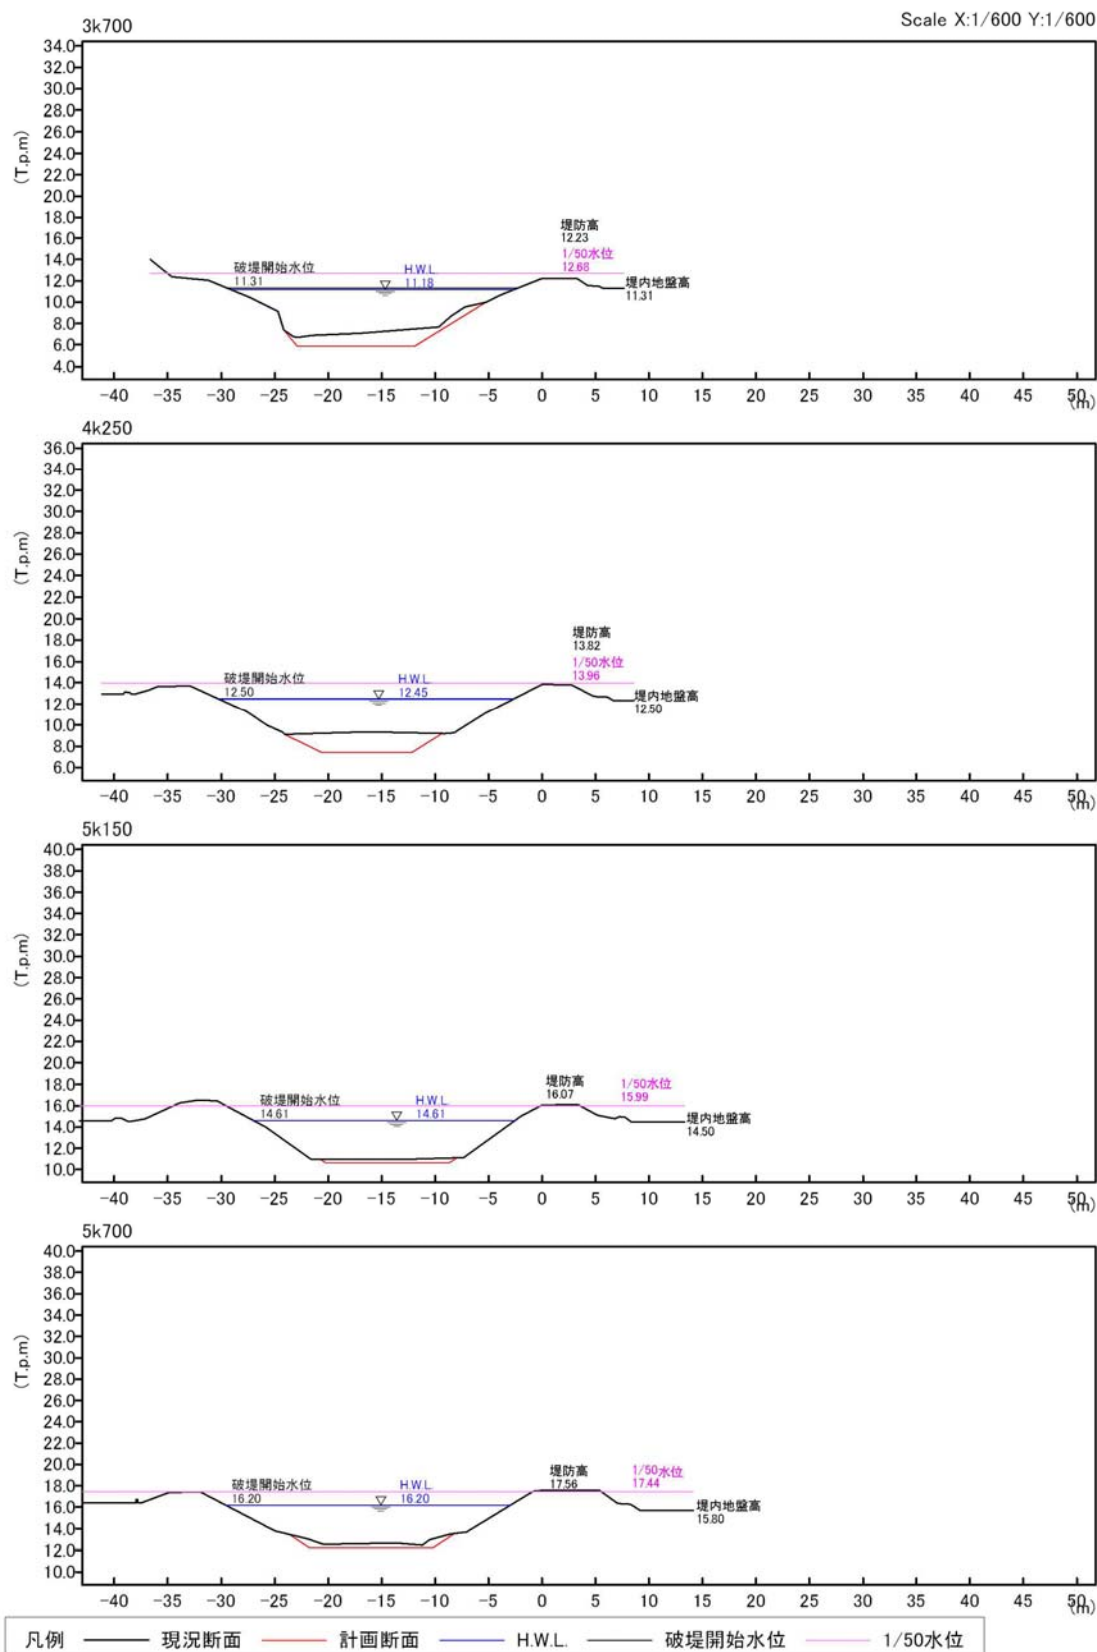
破堤箇所横断面図 都治川右岸 (2/3)
